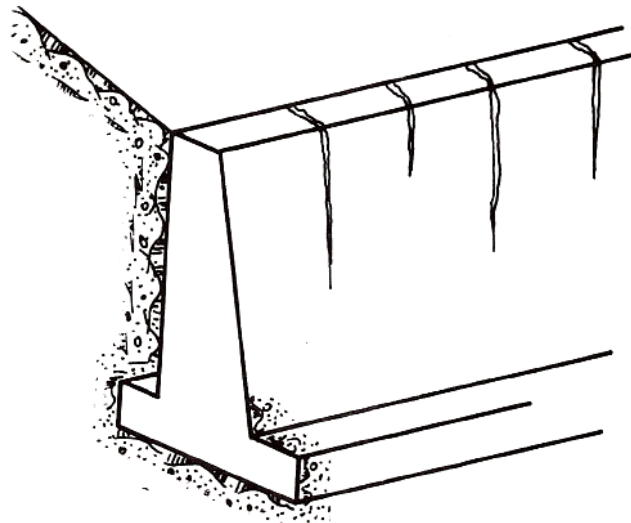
Fisuración de retracción típica de un muro de sostenimiento
